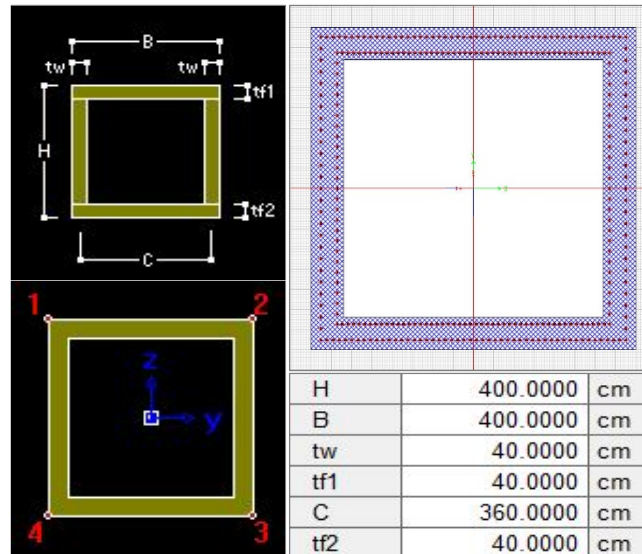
Sección y refuerzo longitudinal de pilas extremas.
